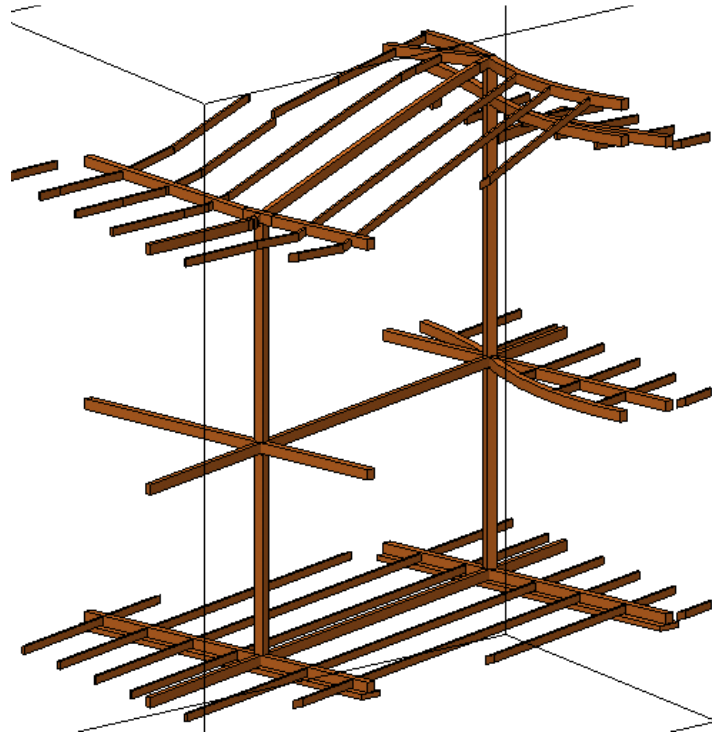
3D e imágenes tipo de de encuentros de pilares vigas y viguetas
